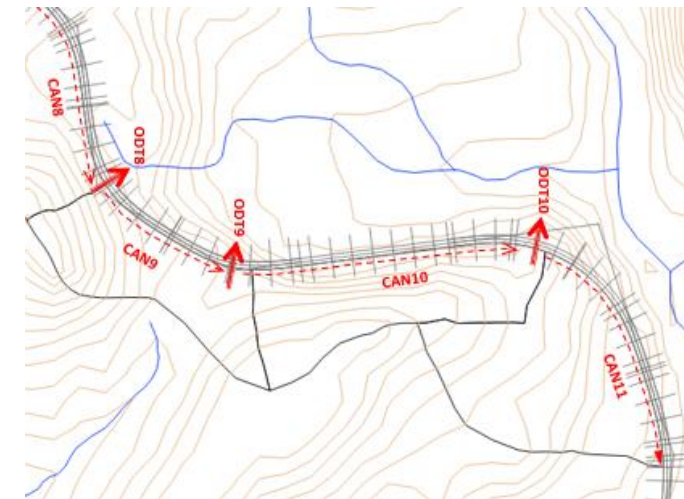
Primer tramo zona norte. Drenaje longitudinal y transversal. Alternativa 1
